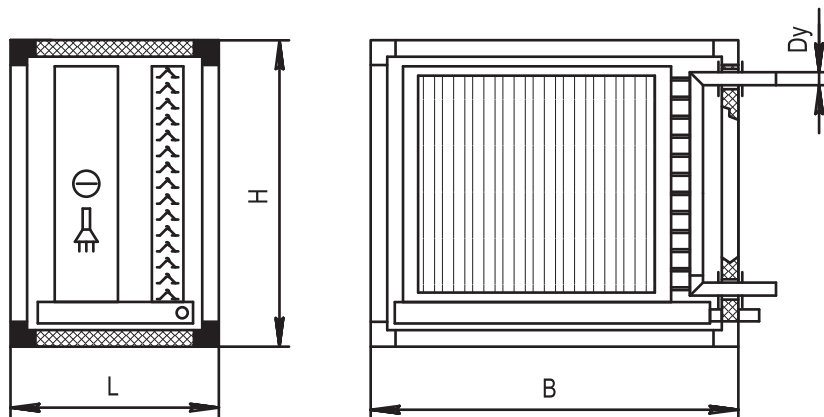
Габаритные размеры блока воздухоохладителя фреонового
